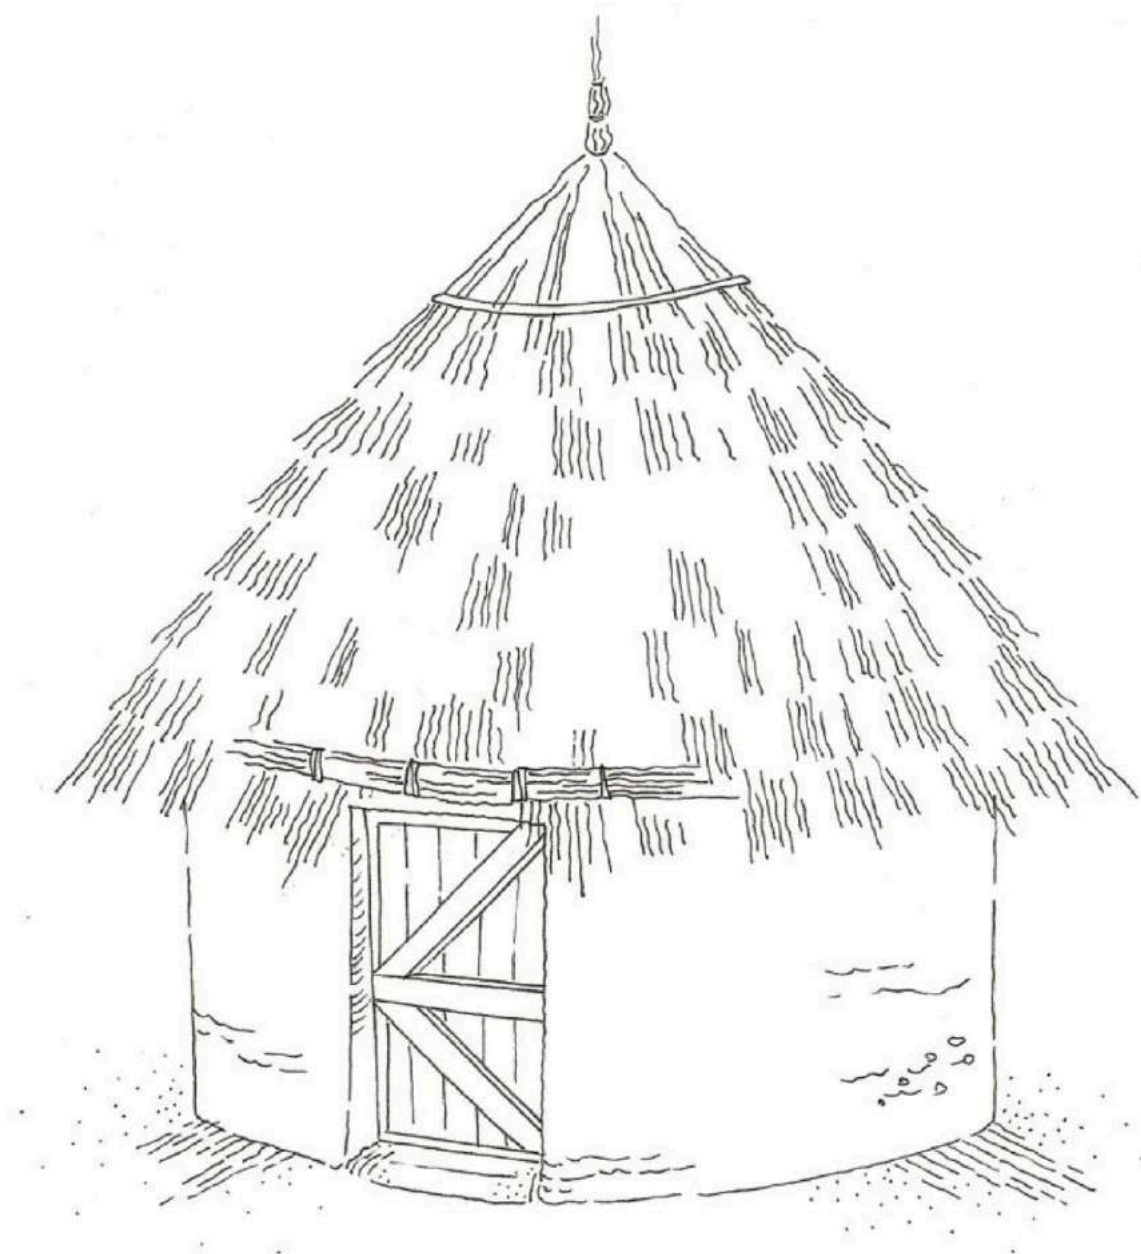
Dibujo de construcción circular ejecutada con muro de COB
